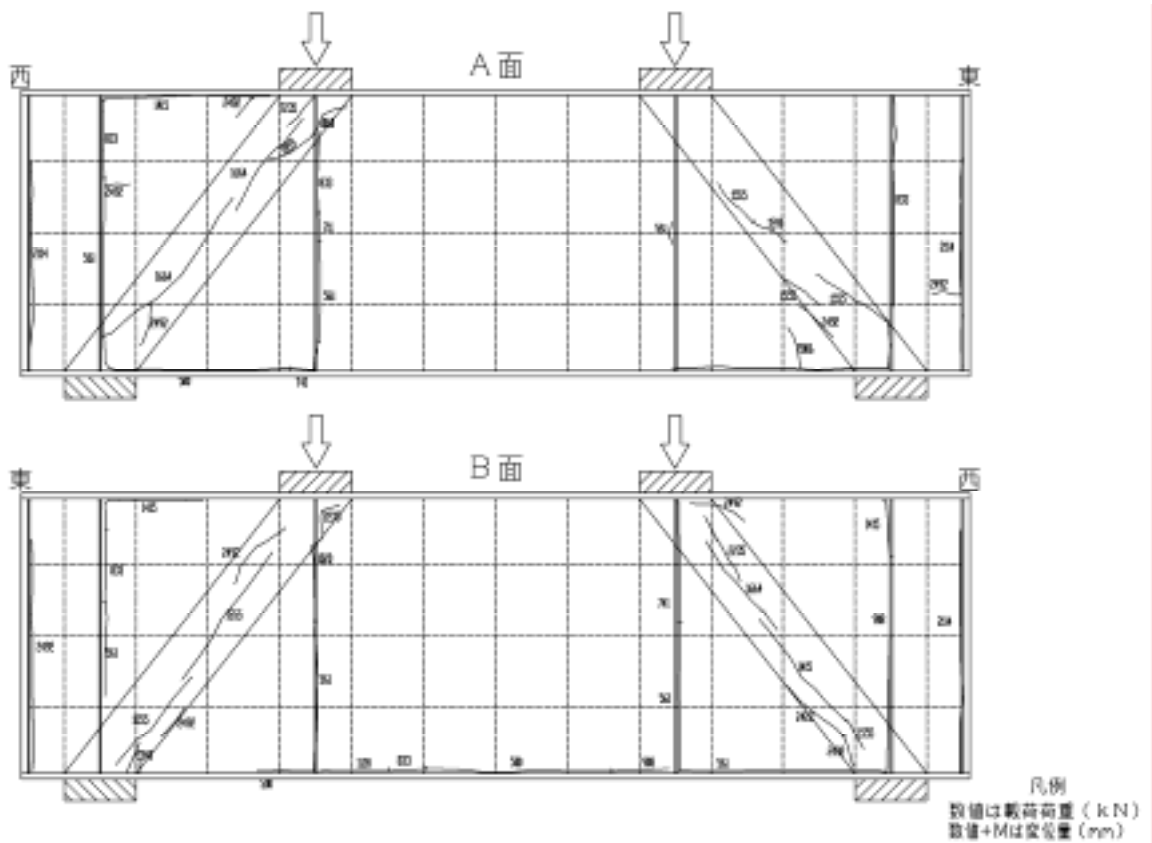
最大荷重時のひび割れ発生状況 (B-2a 試験体)
